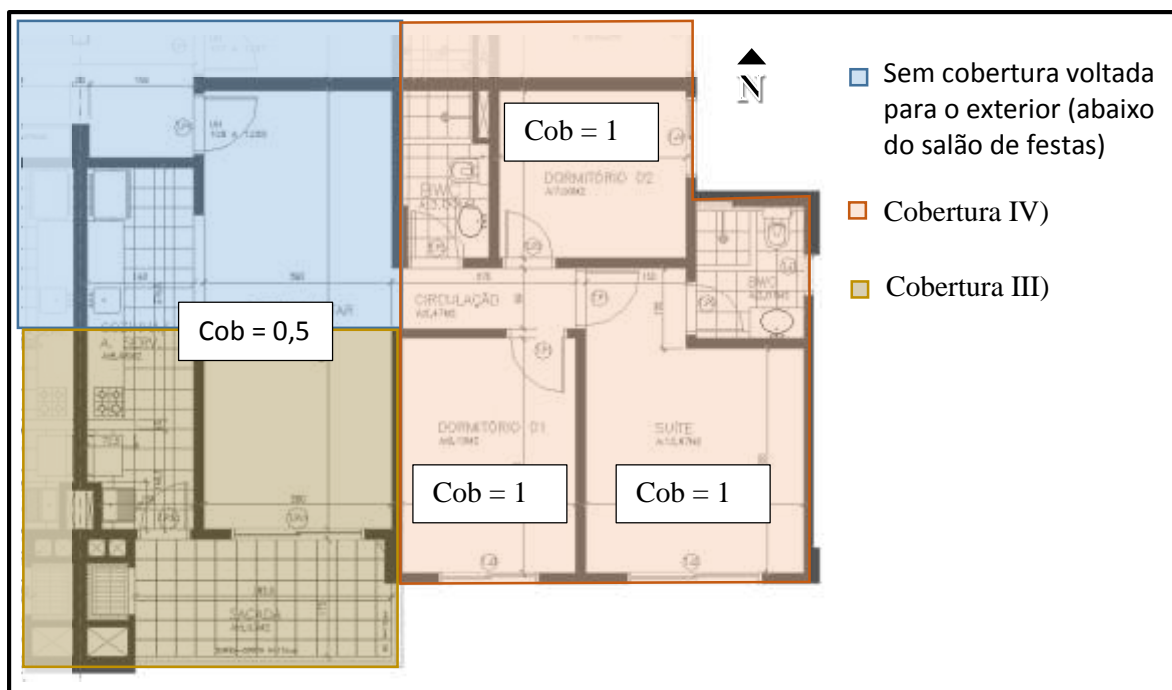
Situação da cobertura Tipologia 2-SE pavimento superior
